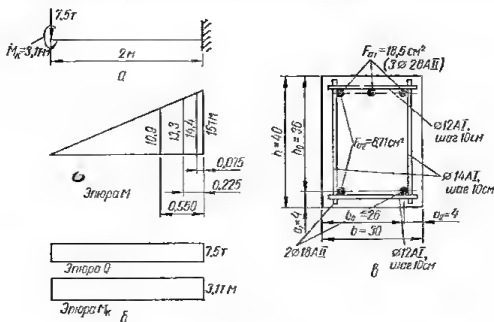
Железобетонная консольная балка, работающая на кручение с изгибом:
